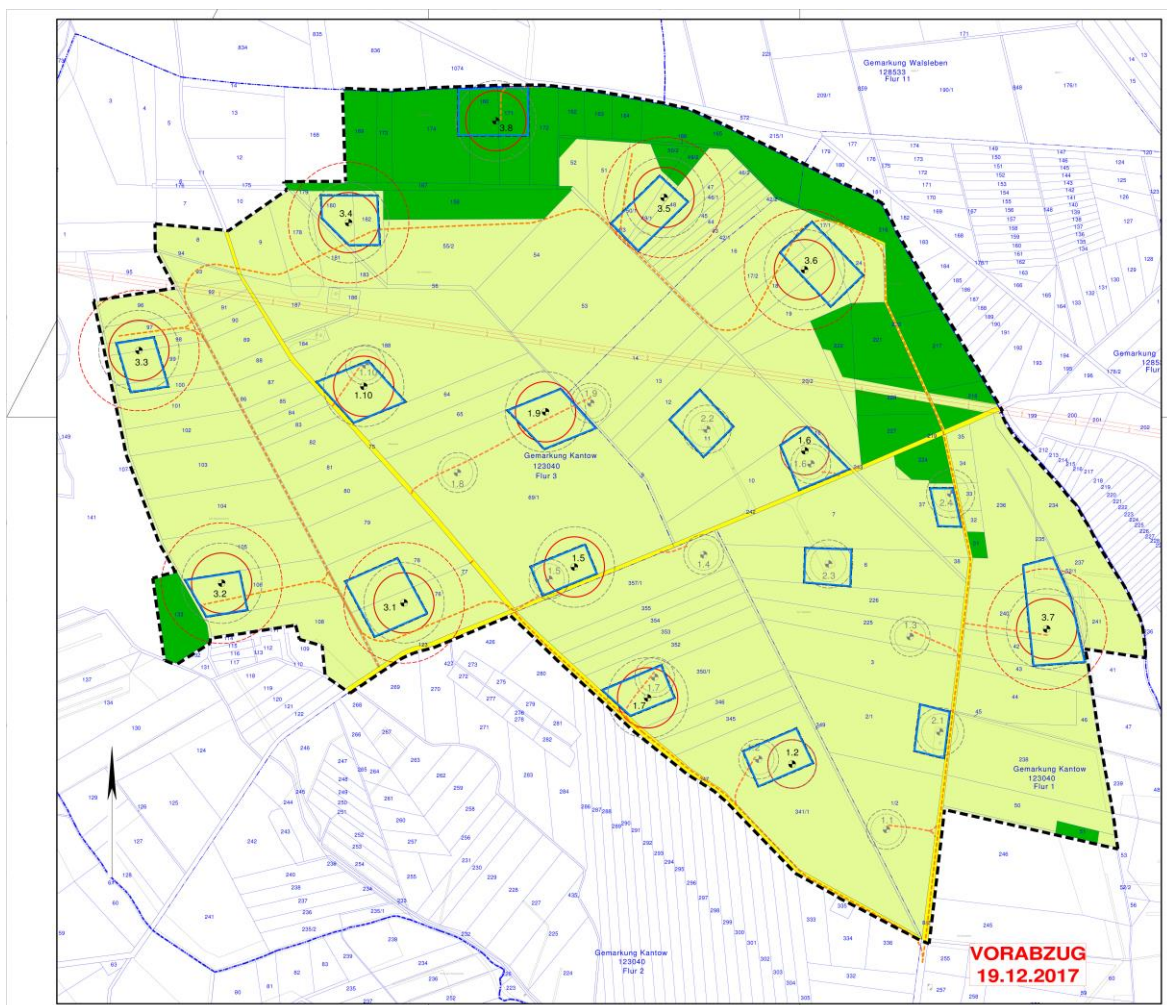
Ausschnitt aus dem B-Plan WP „Kantow“ mit den Baufeldern 3.2., 3.5. & 3.8..
